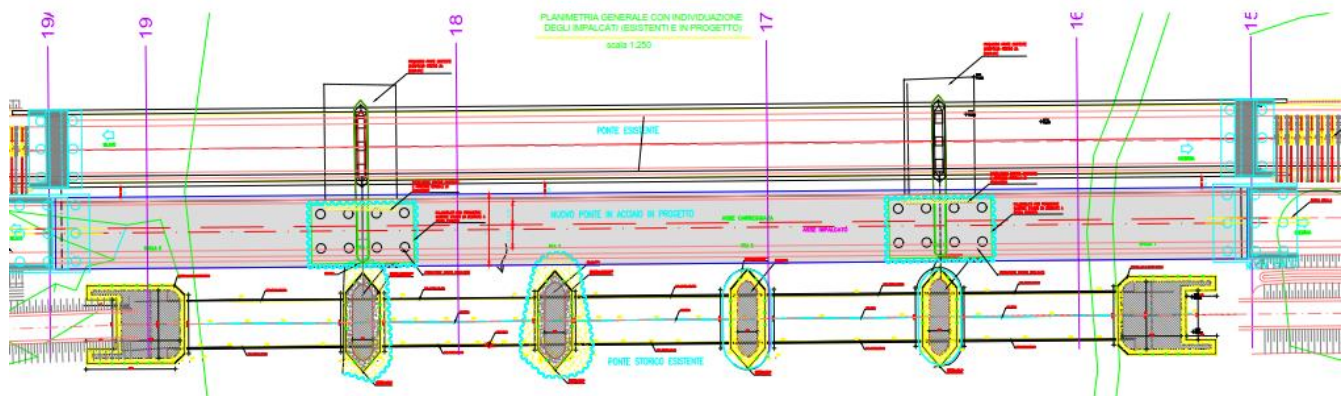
Planimetria dei ponti vicino a Spino d'Adda tratta dagli elaborati progettuali.
